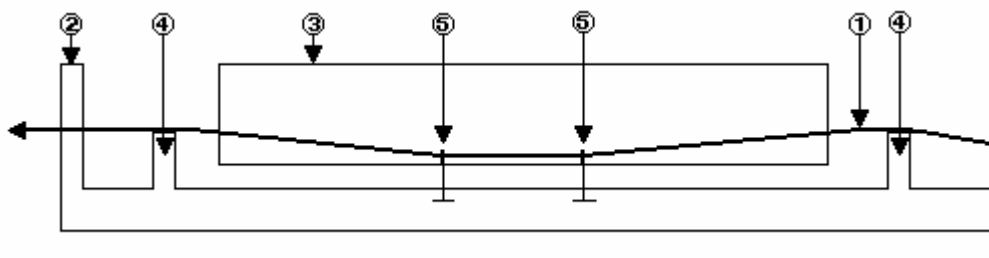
Esquema de execução de vigas com armaduras pré-tracionadas poligonais em leito alongado, permitindo a execução simultânea de várias vigas, em série. 1 – armaduras pré-tracionadas; 2 – placa de ancoragem; 3 – concreto de viga; 4 – pontos de apoio das armaduras poligonais; 5 – pontos de rebaixamento das armaduras poligonais.
